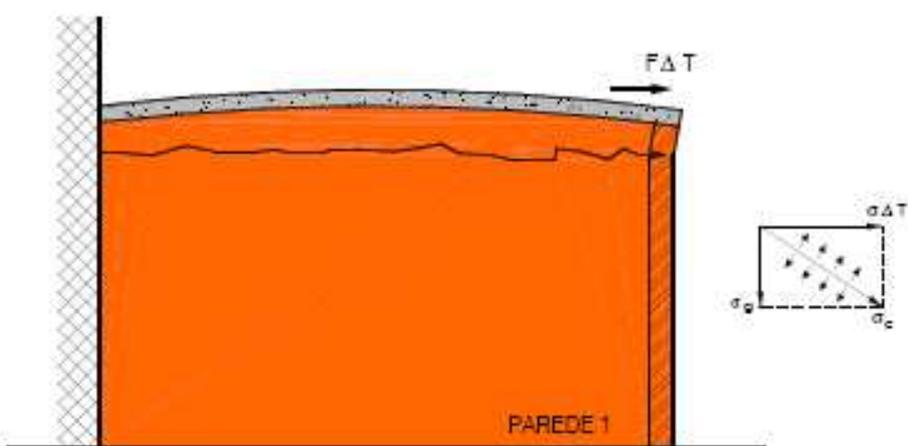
Fissura típica presente no topo da parede paralela à largura da laje.
